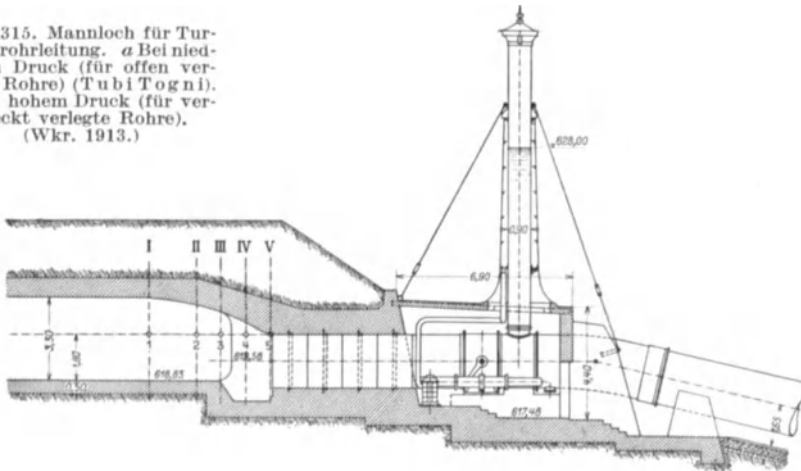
Belüftungsstandrohre mit elektrischer Beheizung und Rohrbruchsicherung, Kanderwerk. (Wkr. 1913.)
